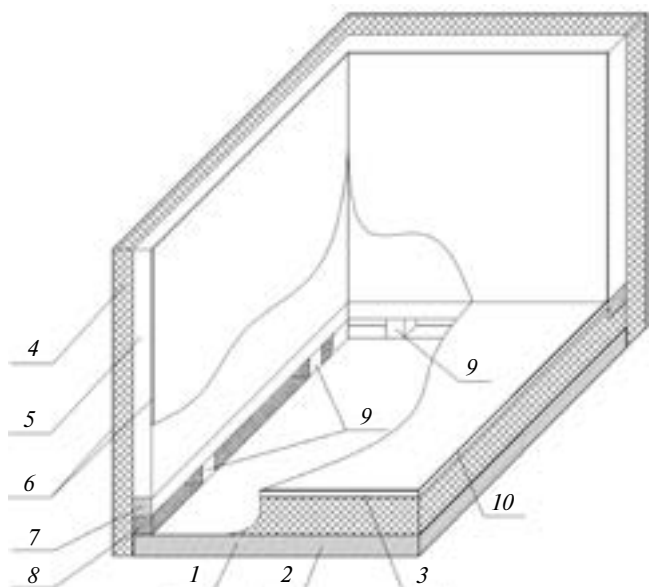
Фрагмент углового соединения наружных ограждений: 1 – монолитная железобетонная плита перекрытия; 2 – теплоизоляция; 3 – цементно-песчаная стяжка; 4 – теплоизоляция; 5 – мелкие бетонные блоки; 6 – штукатурка из цементно-песчаного раствора; 7 – железобетонная балка; 8 – утеплитель; 9 – локальные опоры из армированного бетона; 10 – линолеум.
